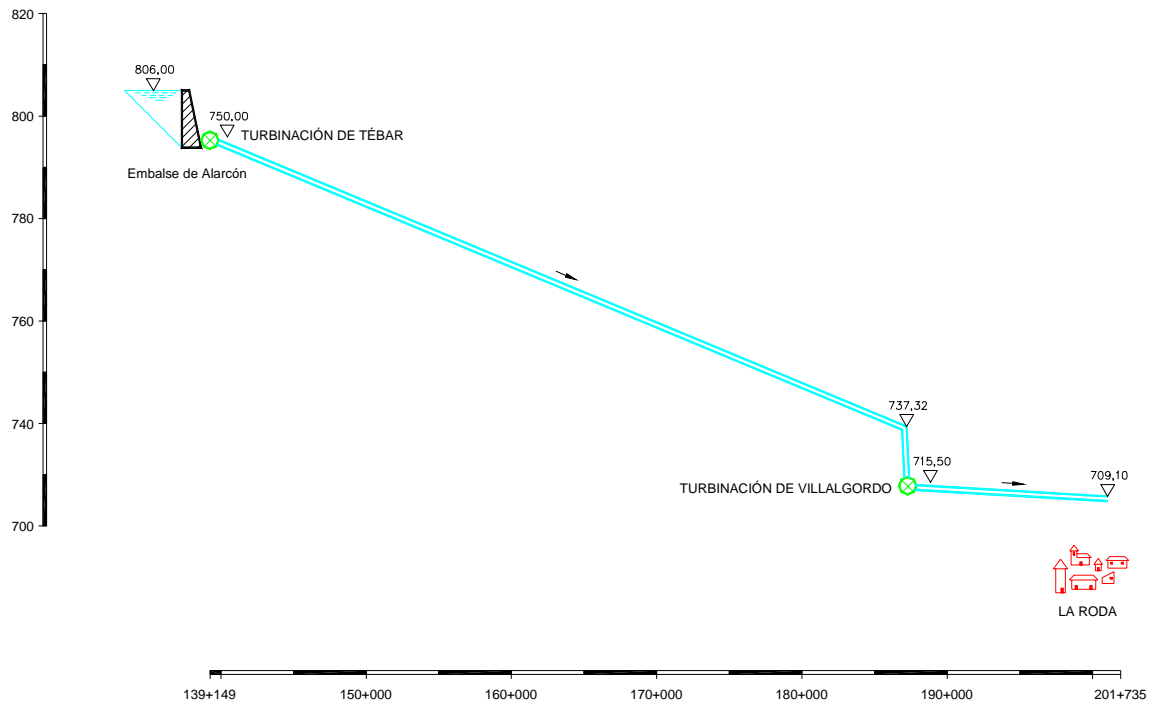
Conducción Alarcón-La Roda. Esquema en alzado
